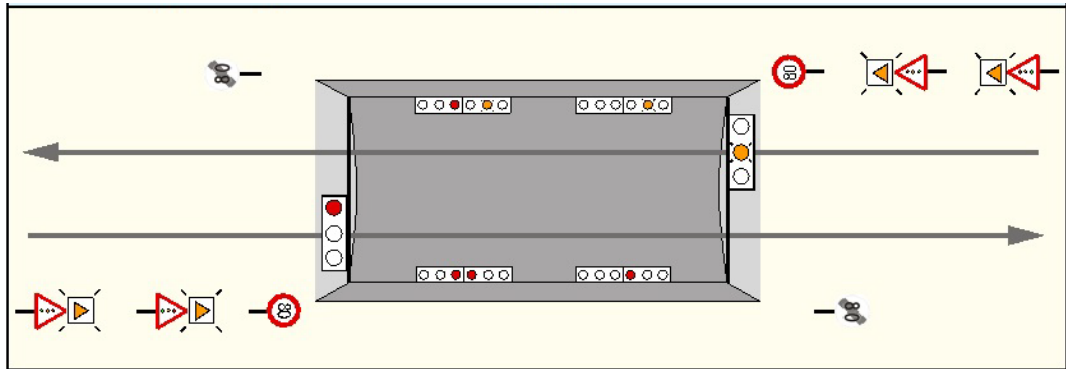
Plan de feux – Fermeture du tunnel dans une direction.
